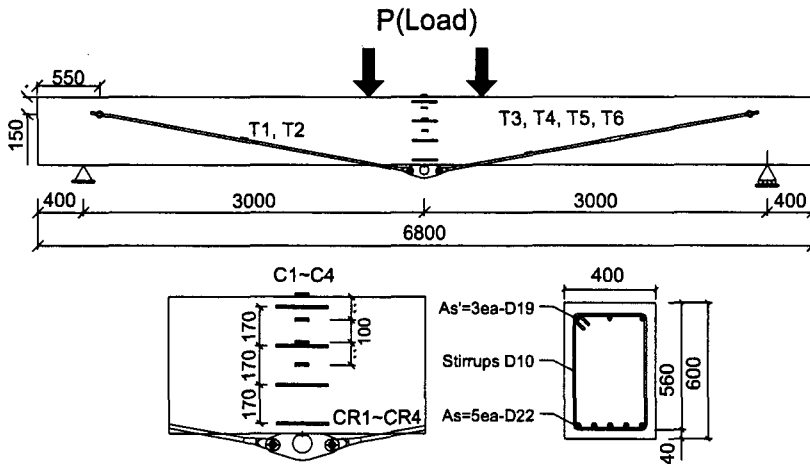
변형도 게이지(W.S.G.) 및 Crack gage 설치위치
